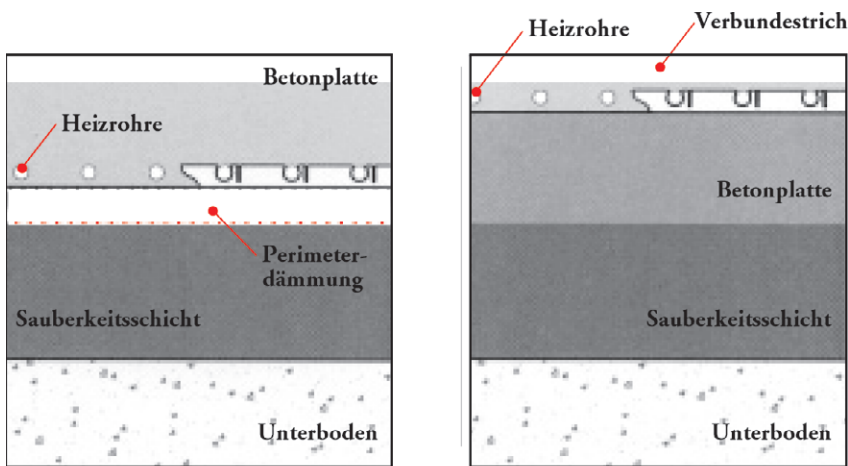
Industrieflächenheizung im Beton und Verbundestrich
